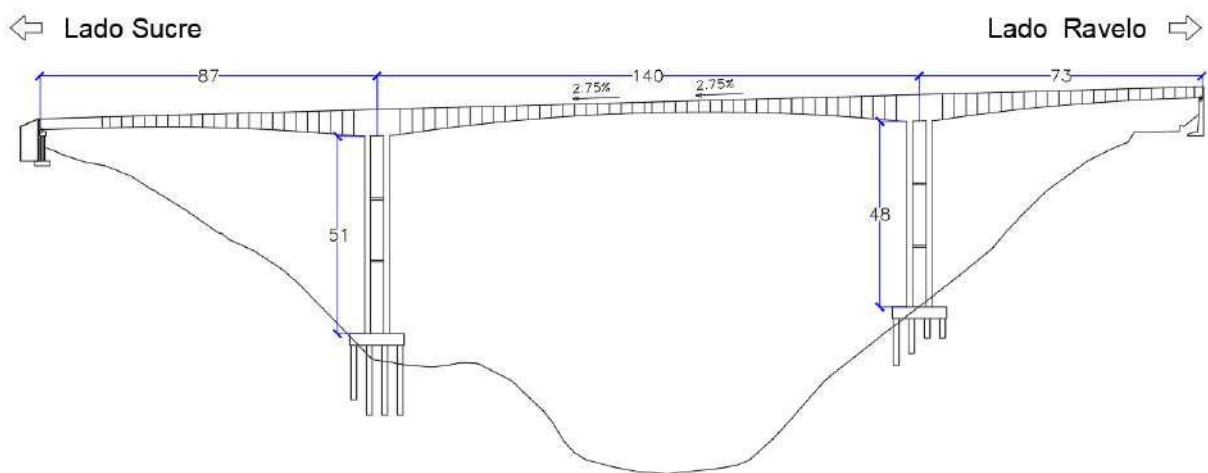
Vista en perfil de la estructura completa del puente Fisculco (dimensiones en metros).
